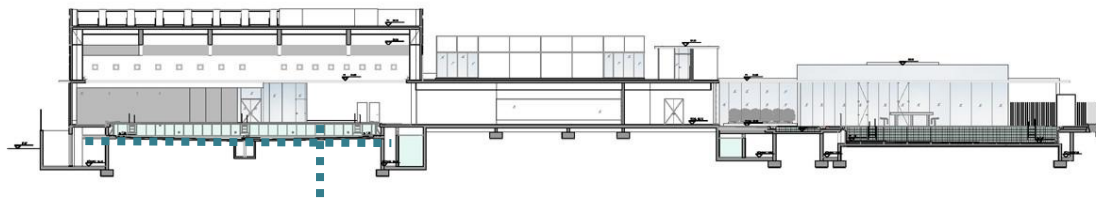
Espacialidad - estructura. (Fuente: <https://www.archdaily.pe> Centro Acuático Deportivo)
